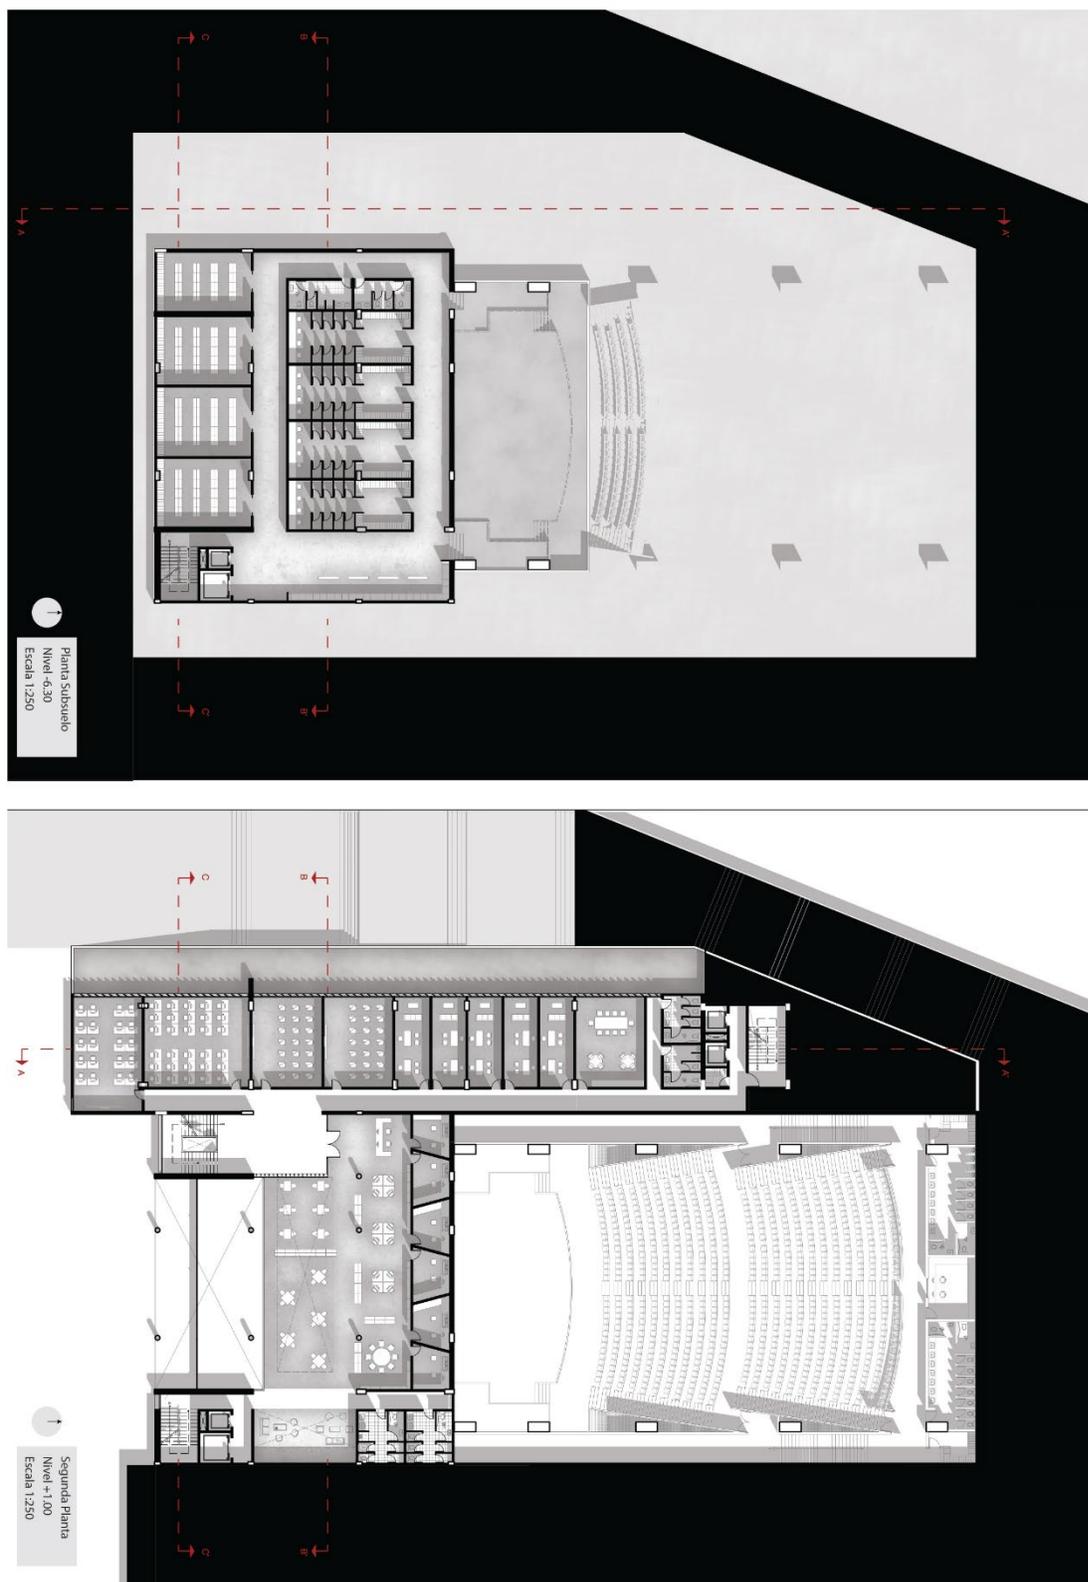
Planta Subsuelo y Planta 2. Elaboración Propia.
